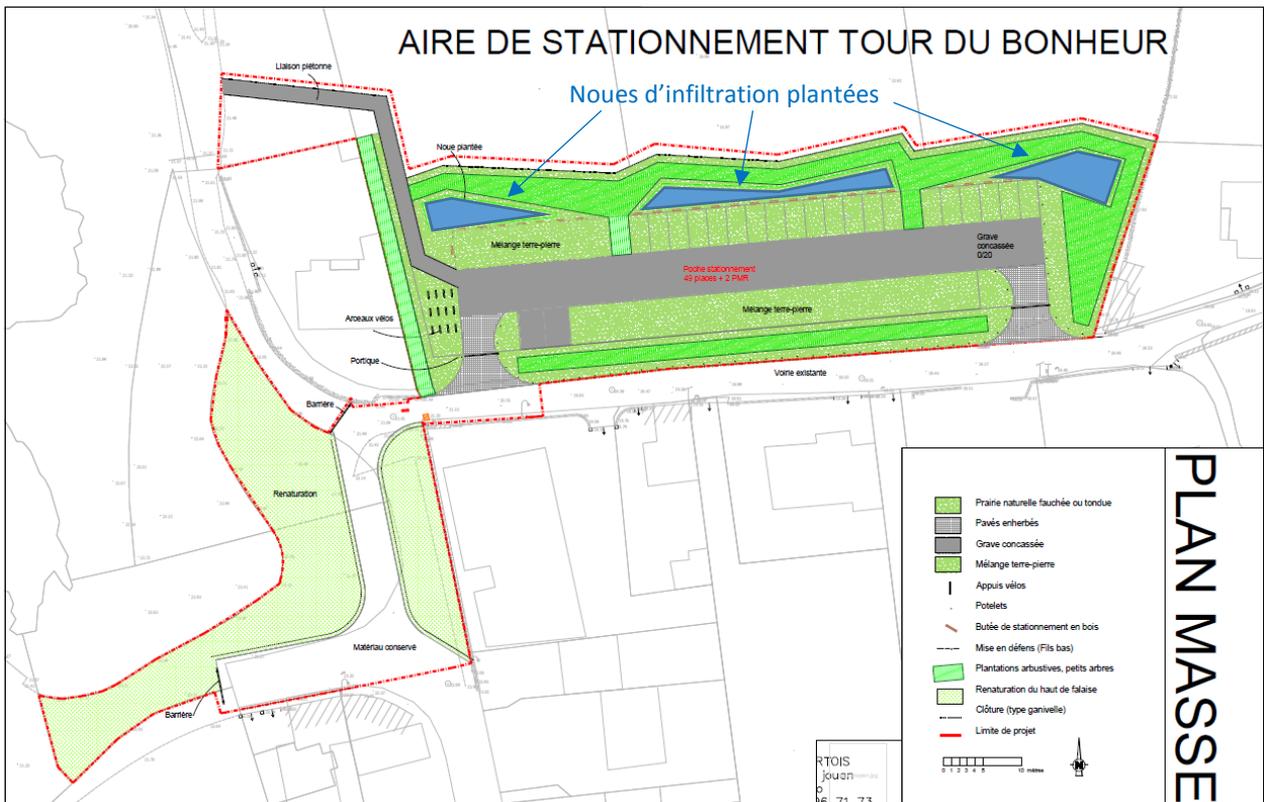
Extrait du plan masse présentant l'emprise de la noue de la Tour du Bonheur (source : DLE, ECR Environnement)
